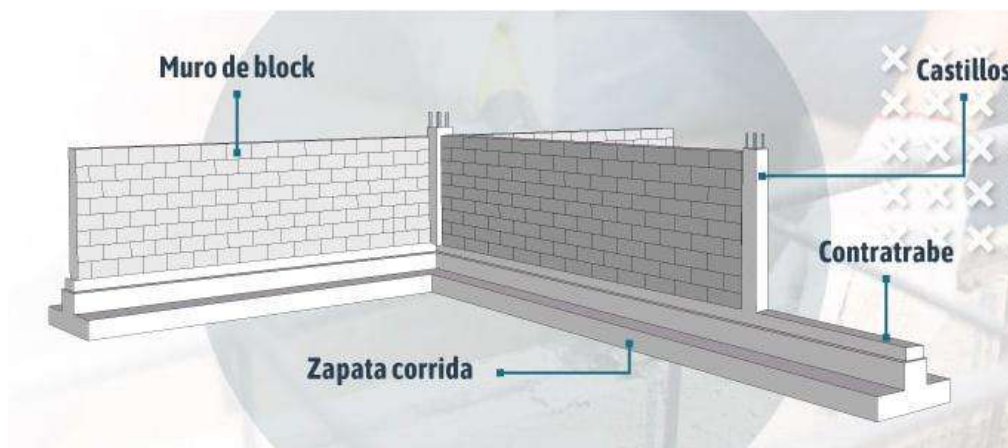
Partes de una pared de bloques de hormigón. Fuente: Panel y acanalado Monterey, 2022
